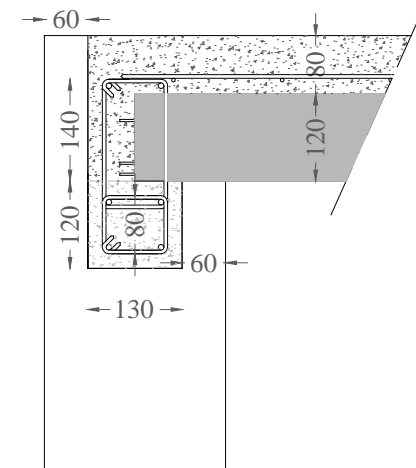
Détail 1 d'une coupe au niveau du plancher en béton armé avec le chaînage horizontal
